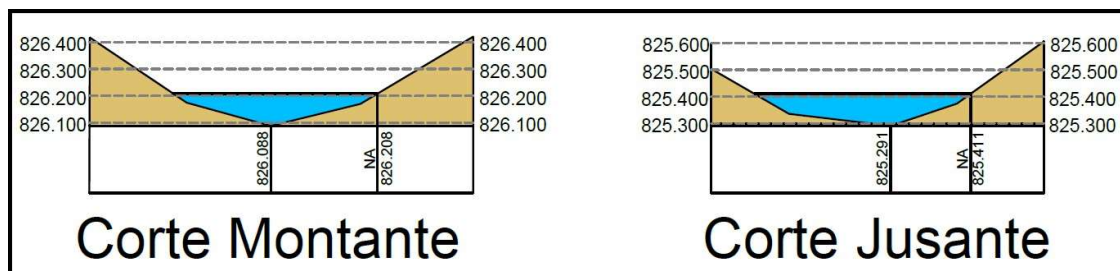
CORTES TRANSVERSAIS LEVANTADOS EM CAMPO
